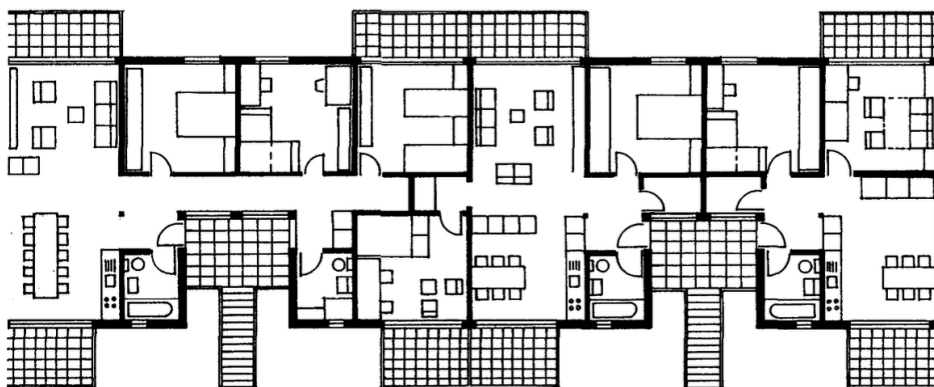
Brahmshof*(1990) - Planta de frações.
